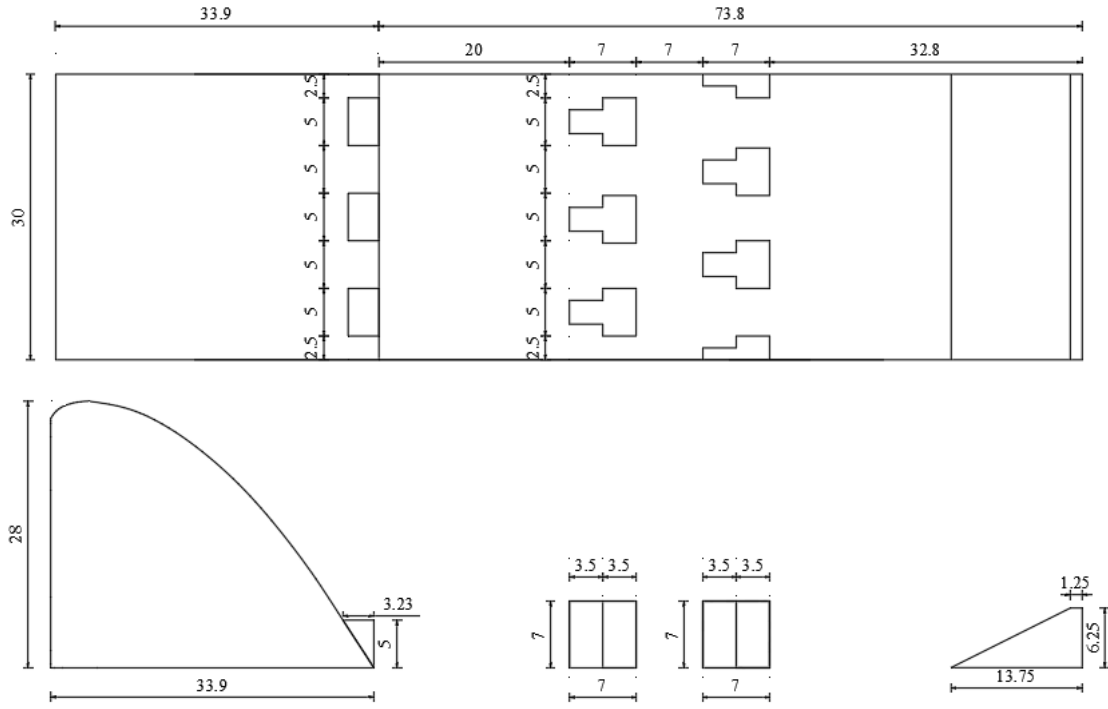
Trapez kesitli çift sıra enerji kırıcı blokların yerleşim planı
